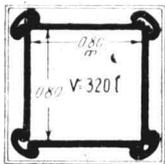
Wasserbehälter aus einfachen Betonteilen ohne Bewehrung.
